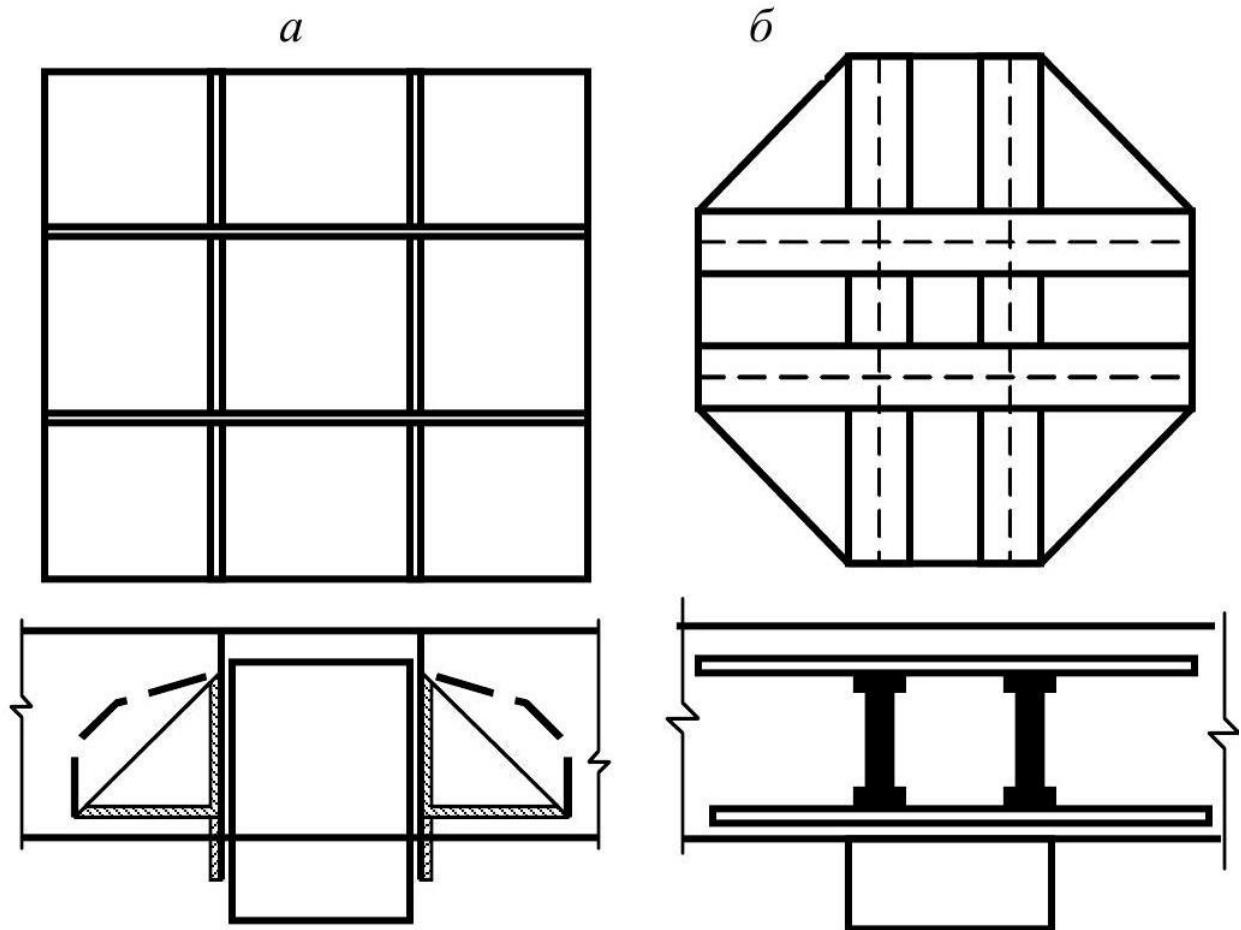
Схеми сталевих комірних: а – з листової сталі; б – з профільованої сталі
